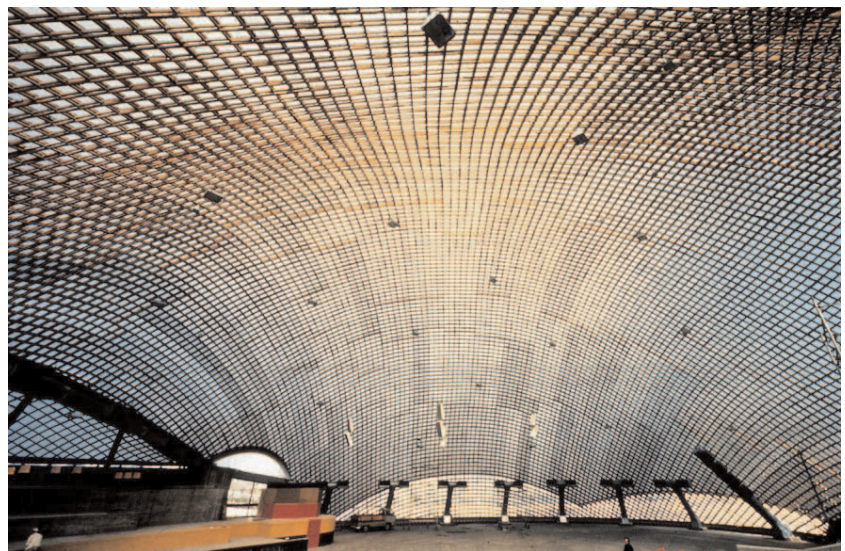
Pabellón de Mannheim en construcción. Fuente: Archivo IL, diapo. 2.71.13
